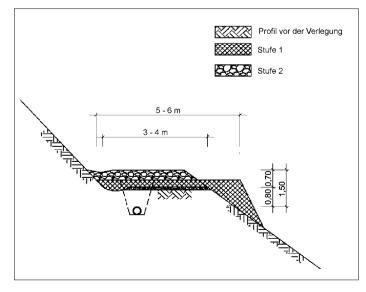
Schemaskizze Wegebearbeitung im Hochschwarzwald
